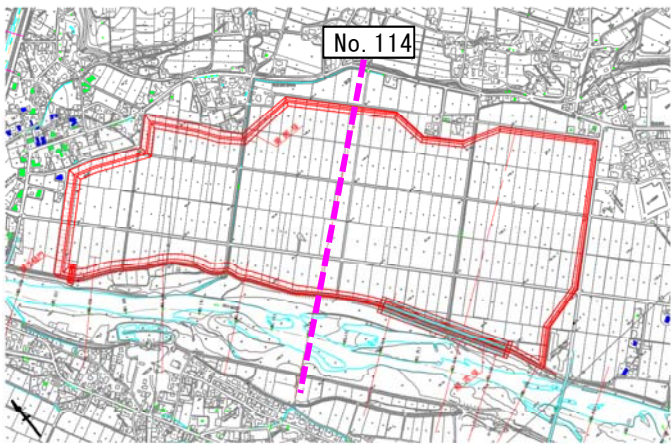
遊水地②（11.8k 右岸）平面図
